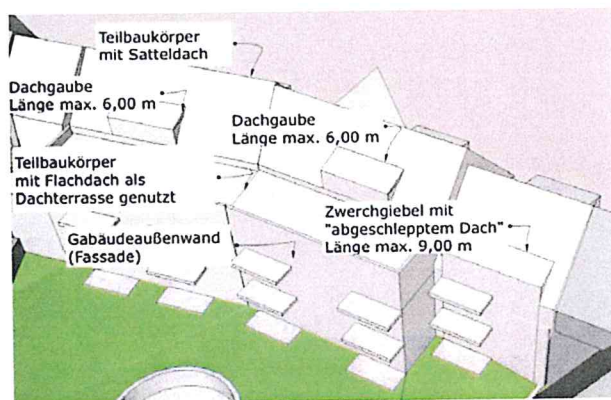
„Dachgauben und Zwerchgiebel - Innenhof“
